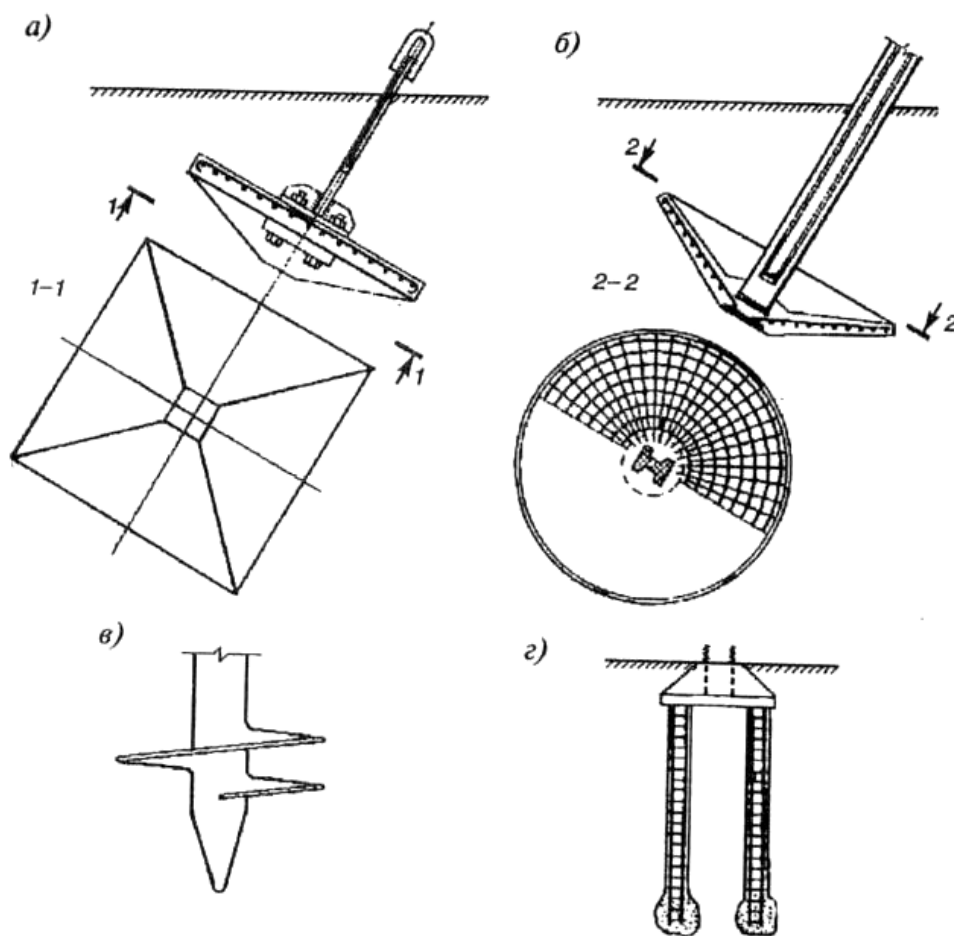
Анкерные фундаменты: а – плитный фундамент; б – открытая коническая оболочка; в – винтовая свая; г – набивные сваи
